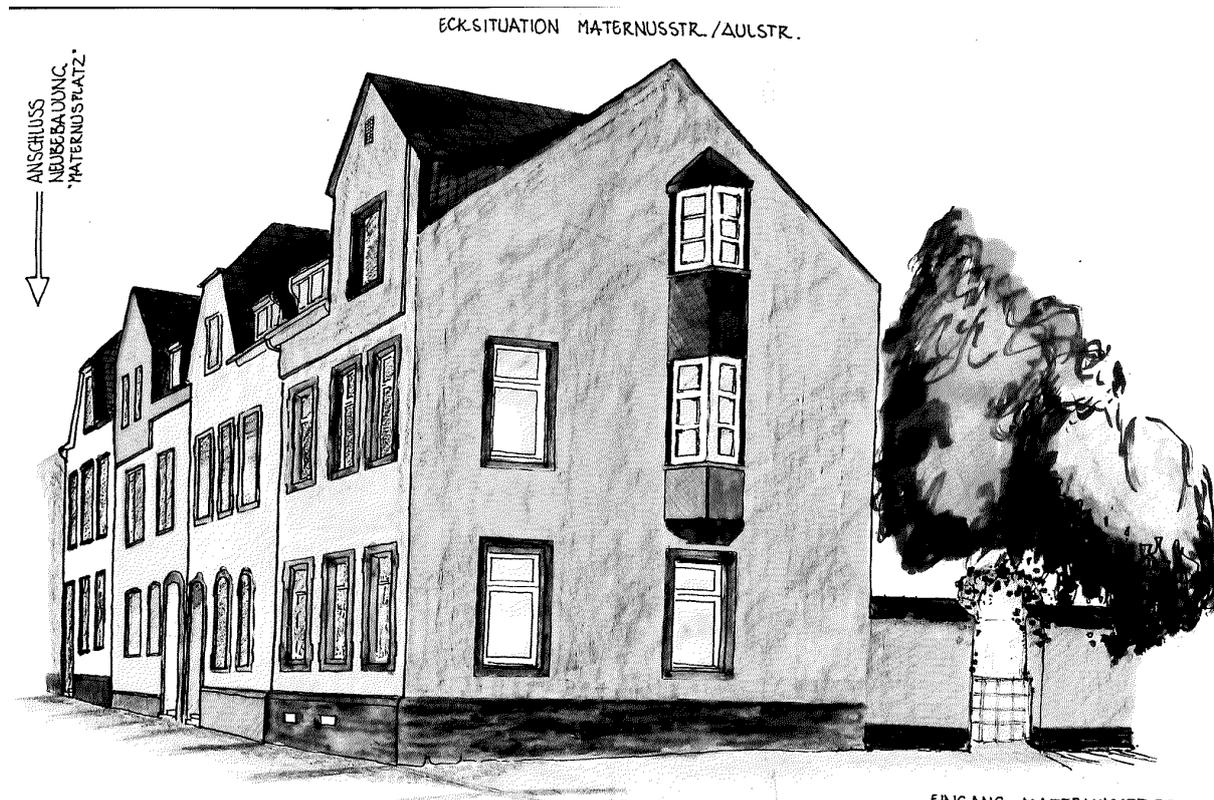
Gestaltungsentwurf Maternusstraße 32 (Stadtplanungsamt, undatiert)
